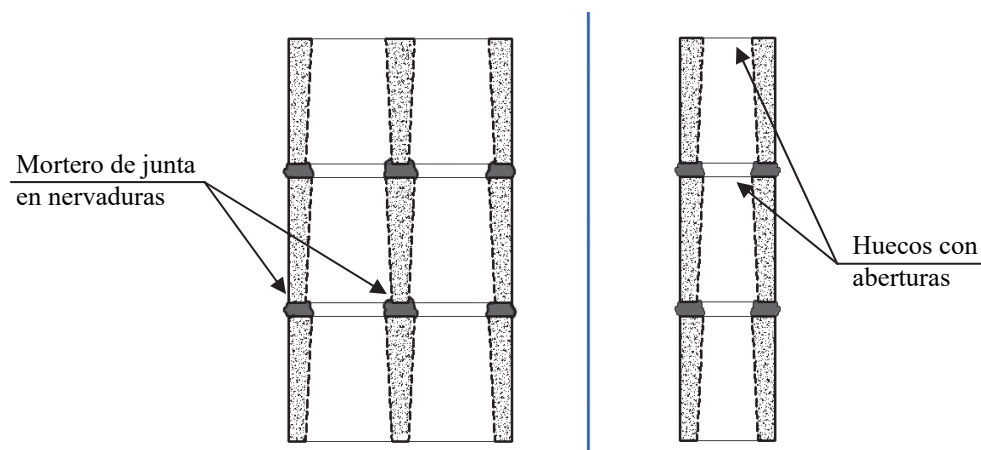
Corte longitudinal-transversal. Albañilería elaborada con bloques de hueco pasado.
